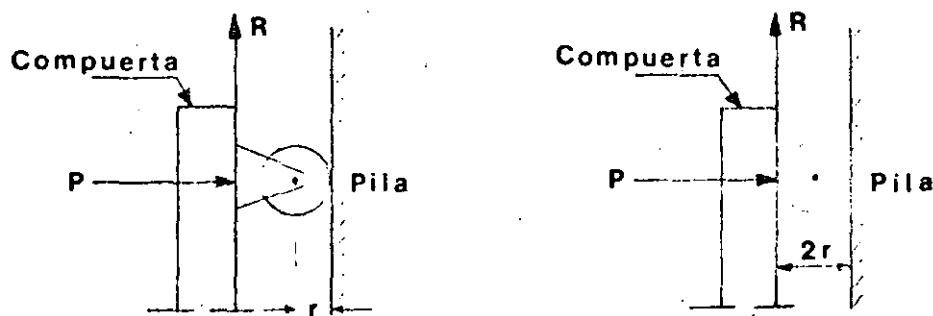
Rodillos unidos a la compuerta y entre compuerta y pila.
